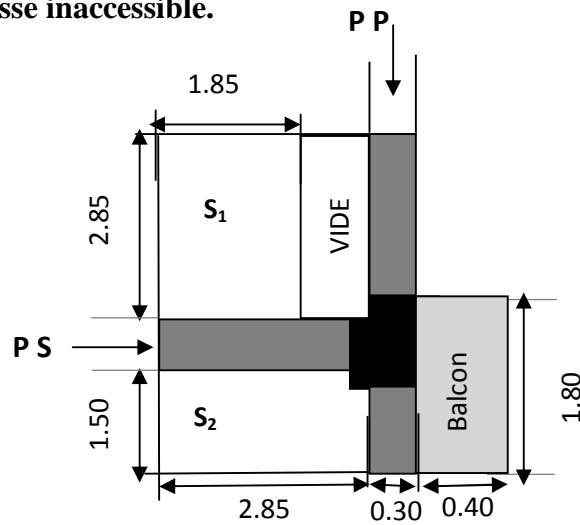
a : Surface revenant au Poteau de la cage d'escalier C-4(Terrasse inaccessible)
